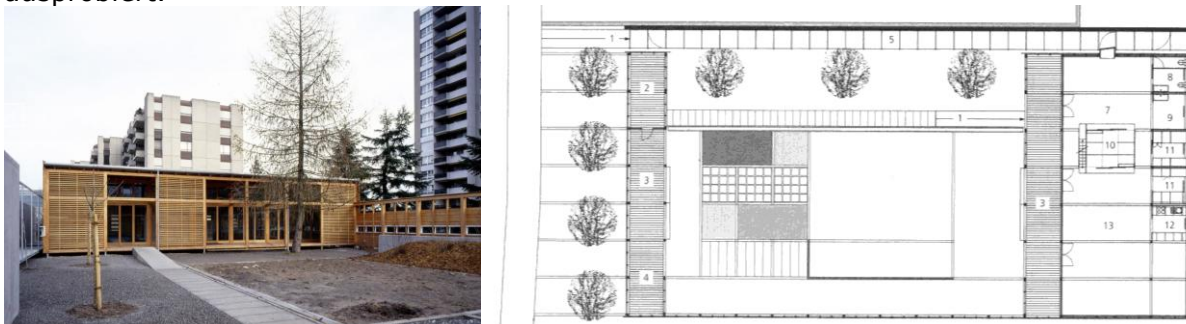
Kindergarten Morillon in Bern, Bild und Grundriss / Bauart Architekten und Planer AG
